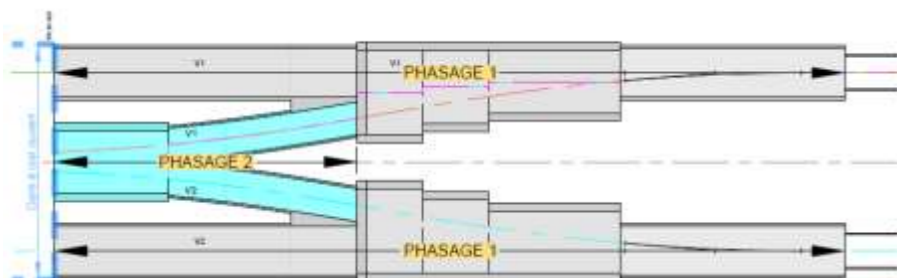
Vue en plan de l'entonnement est (EGIS, 2021)
